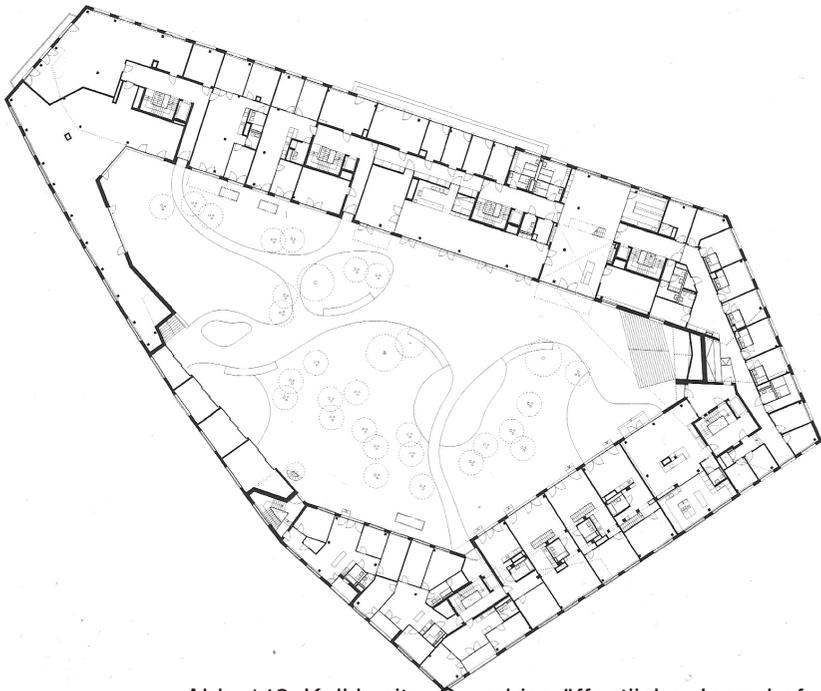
Kalkbreite, Grundriss öffentlicher Innenhof und 2.OG
